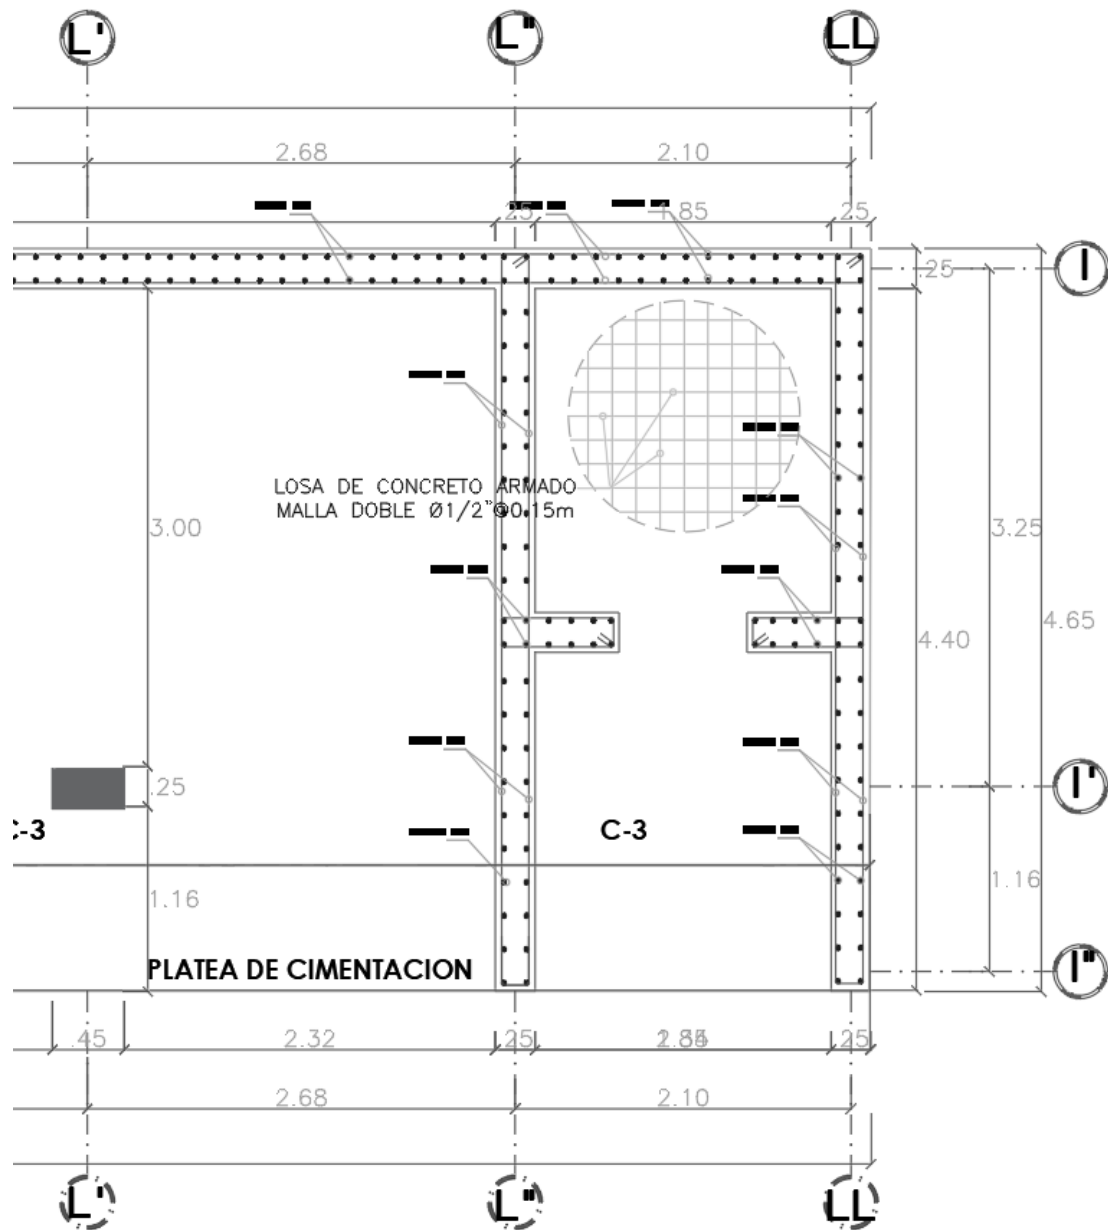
Planta de cimentación con placas. Fuente: Elaboración Propia.
